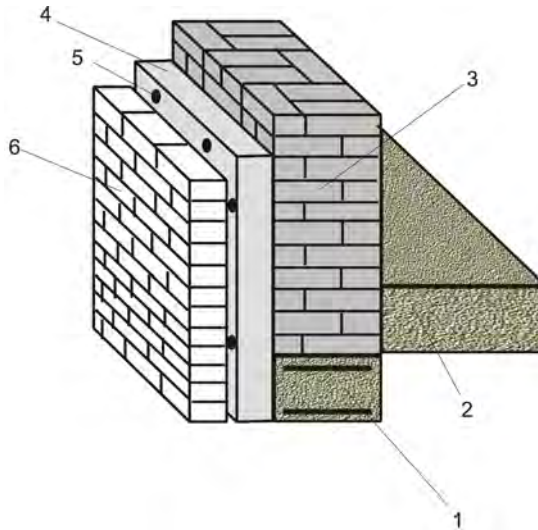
Трехслойная кладка: 1 — монолитно-армированный пояс; 2 — железобетонная плита перекрытия; 3 — внешняя стена из полнотелого кирпича, керамического щелевого кирпича или силикатного кирпича; 4 — теплоизоляционный слой 100–120 мм, в качестве которого можно применить минераловатные плиты; 5 — базальто-волоконистые связи с фиксирующим кольцом (кольцо необходимо для плотного прижимания теплоизоляционной плиты к поверхности кирпичной стены, расход колец составляет 6–7 шт./м²); 6 — кладка из лицевого кирпича, выполняемая с созданием вентиляционного зазора 30–50 мм
